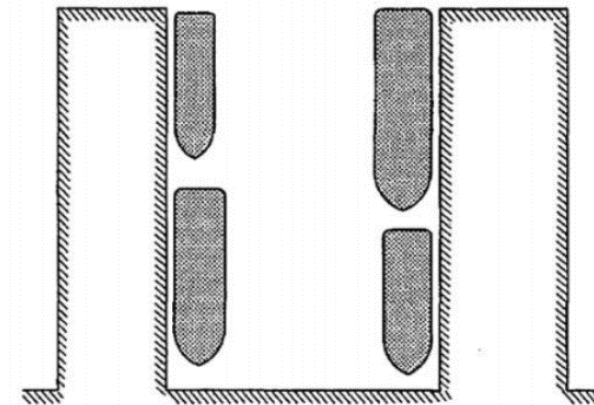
Dermaga Tipe *Wharf* atau *Quay
